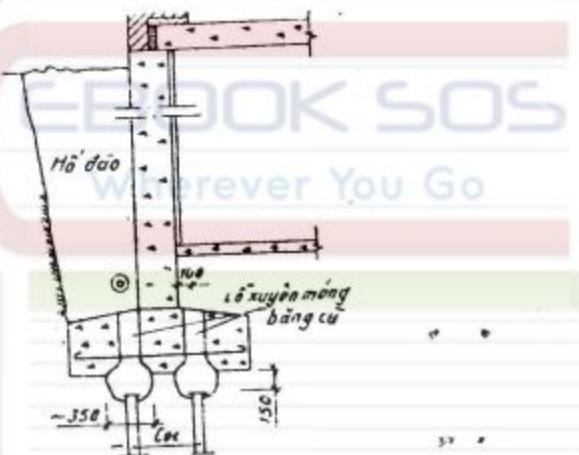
trình bày mặt bằng bố trí cọc gia cường cho một công trình, trong đó hệ truyền tải là những dầm bê tông cốt thép được ngầm vào móng cũ. Cọc được đóng xuống trước sau đó các dầm truyền tải được đổ bê tông lên trên.
